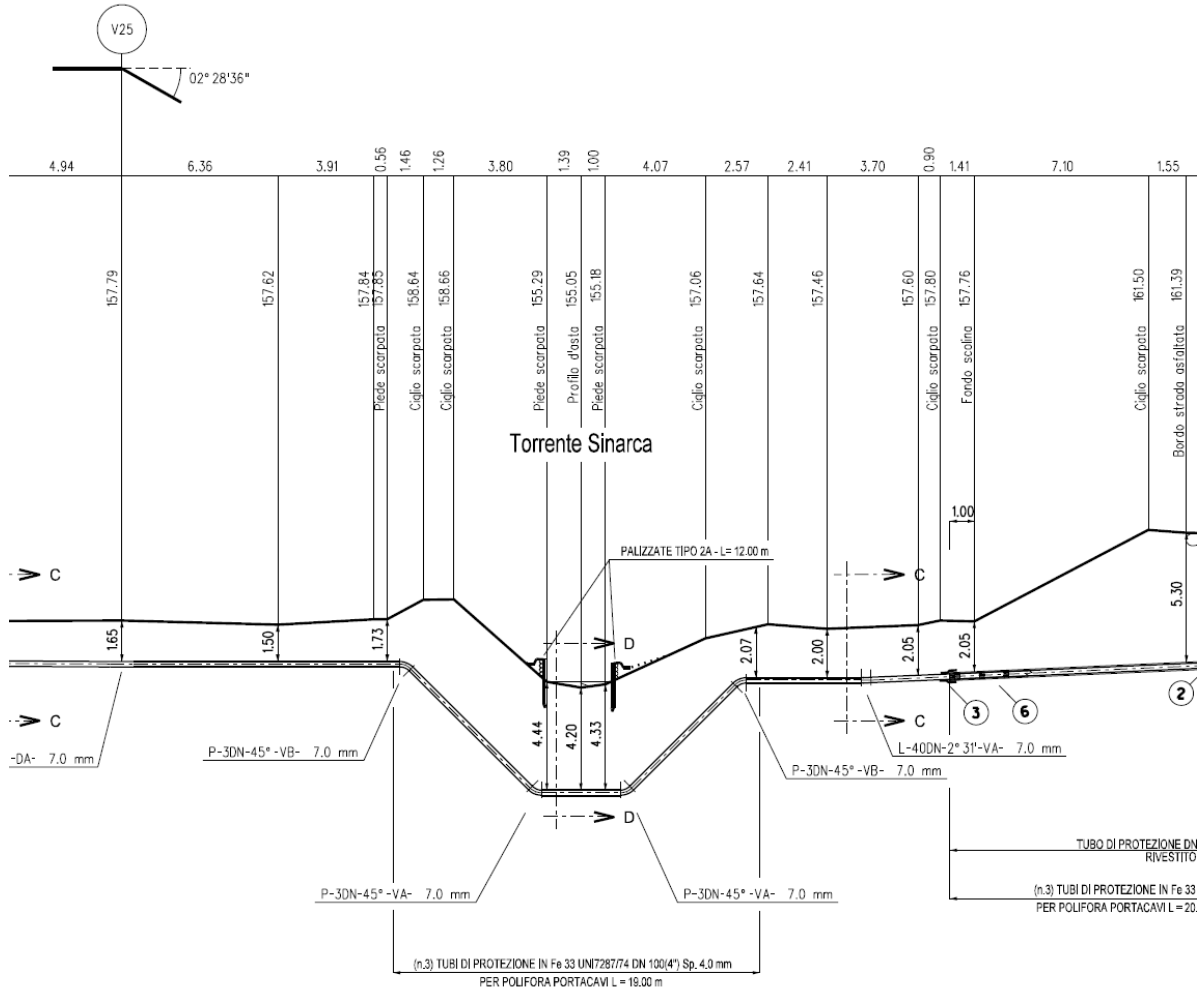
attraversamento Torrente Sinarca - Sezione schematica di progetto
